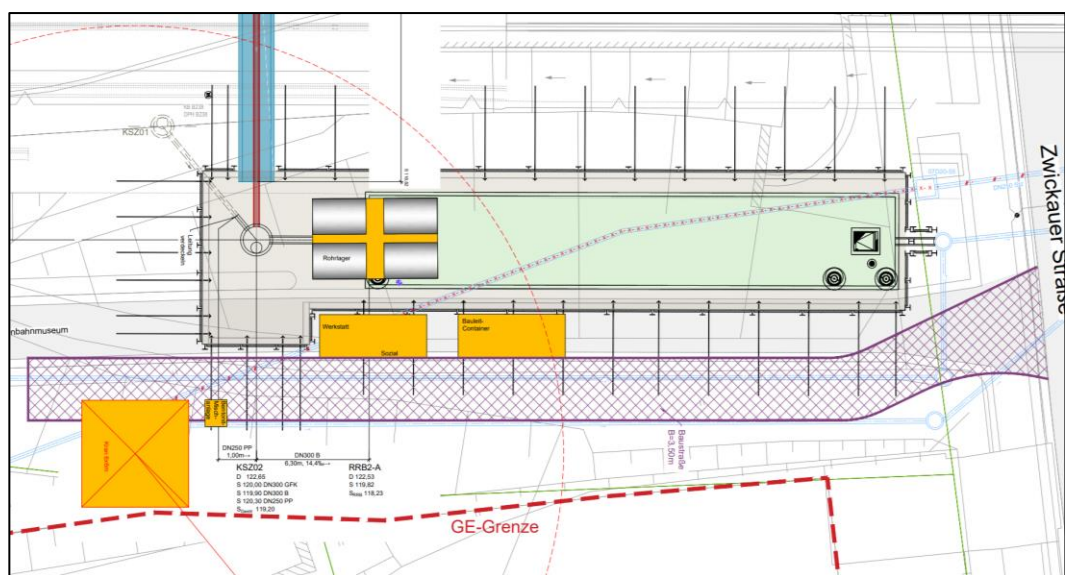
schematische Darstellung Baustelleneinrichtungsfläche Startgrube
